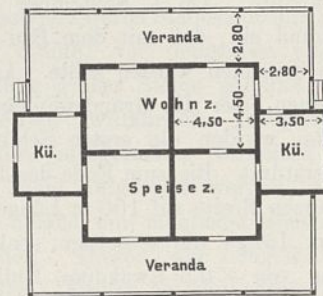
u. 13. Wohnhaus für den Bauleitenden.
